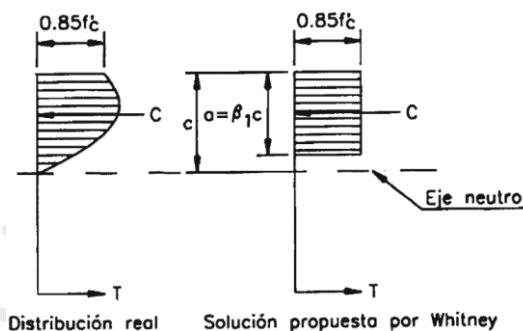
Distribución de esfuerzos en el concreto en compresión de la viga¹⁹
